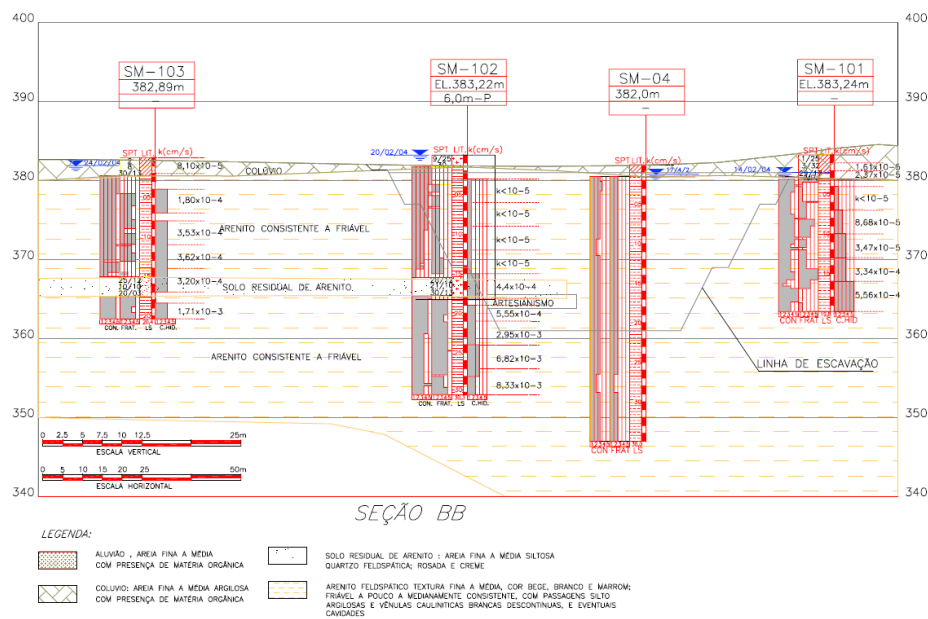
Perfil geotécnico na seção BB com localização das sondagens e linha de escavação (Corrêa, 2006).
